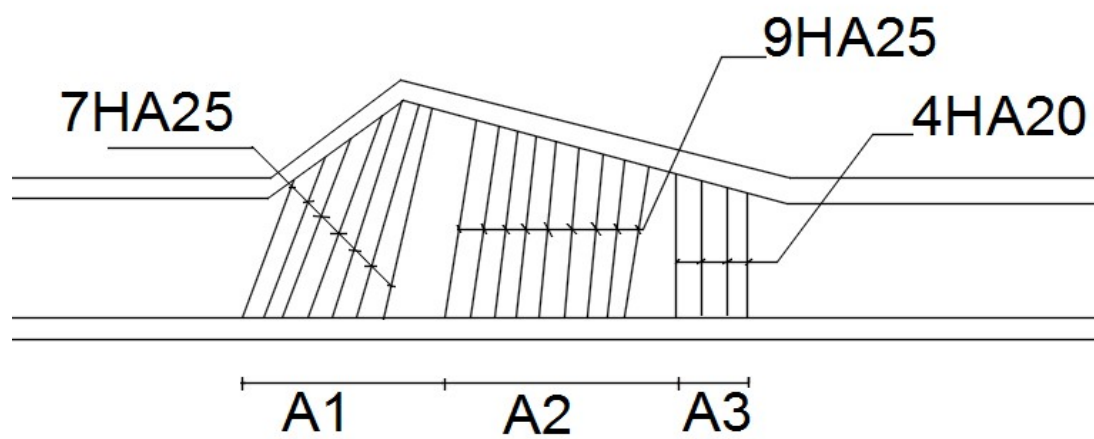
Ferrailage des bossages de la dalle inférieure.
